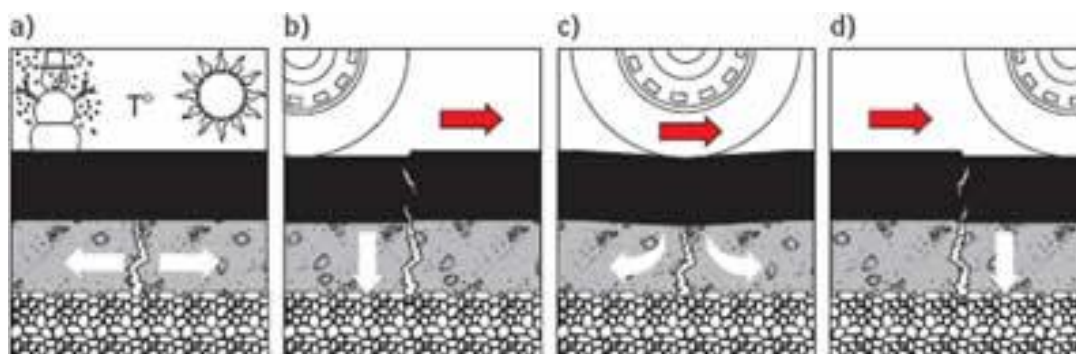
Solicitações mecânicas em um pavimento trincado que causam reflexão de trincas (Fonte: Revista Técnica)
